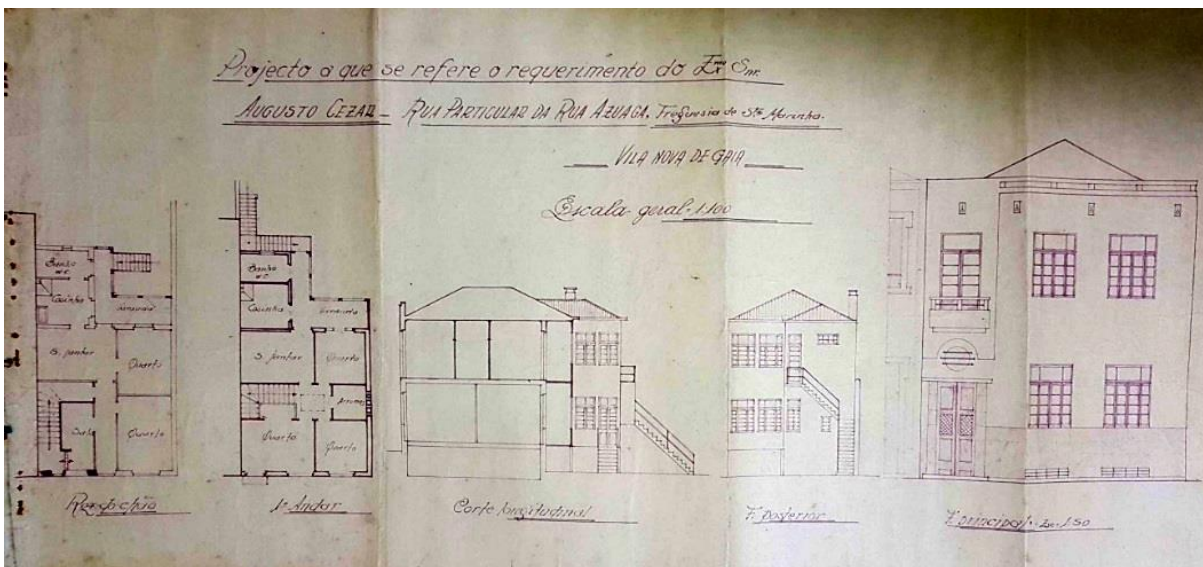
Planta de Projeto de Possível Ampliação do Edifício
